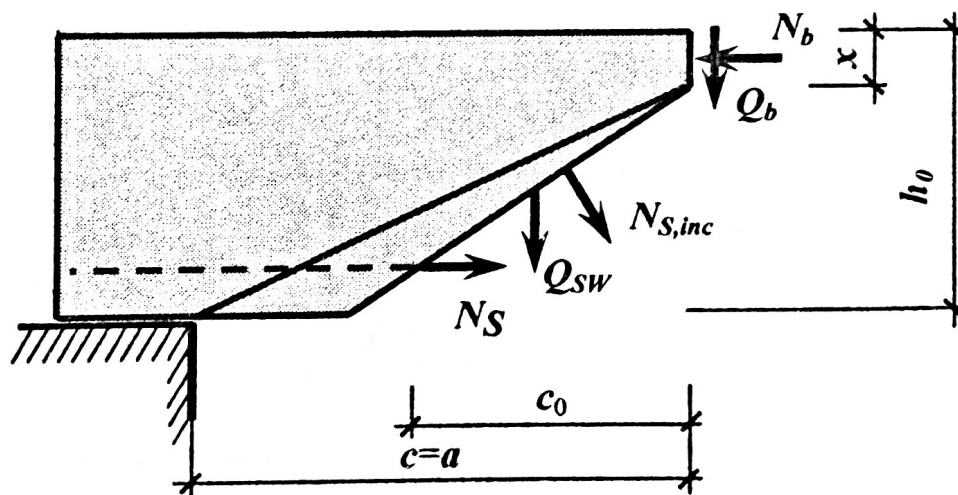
Схема внутренних усилий в наклонном сечении изгибаемого железобетонного элемента по СНиП 2.03.01-84*.
